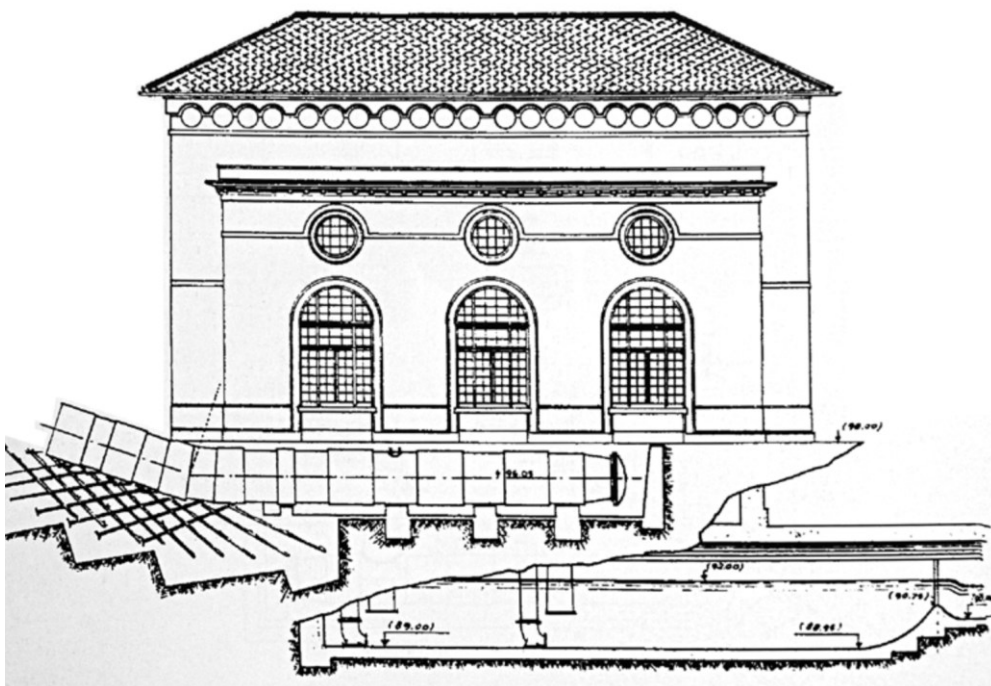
Prospetto con quote di adduzione e restituzione della centrale di Castelletto
